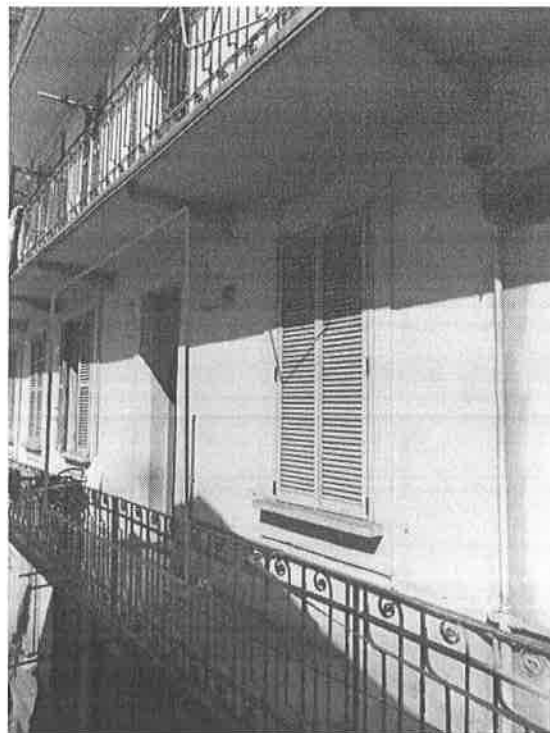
Scorcio, dal ballatoio comune, dell'affaccio dell'unità pignorata, evidenziata dal poligono rosso.
